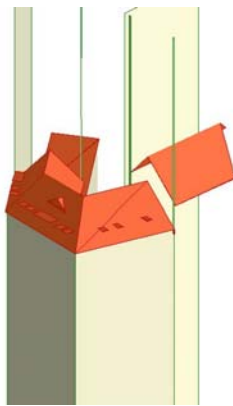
Verschneidungsfehler in ArchiCAD. Links wegen Lageungenauigkeiten zwischen Dach- und Grundrissflächen, rechts wegen nicht geschlossener Dachflächen [Eigene Darstellung]
